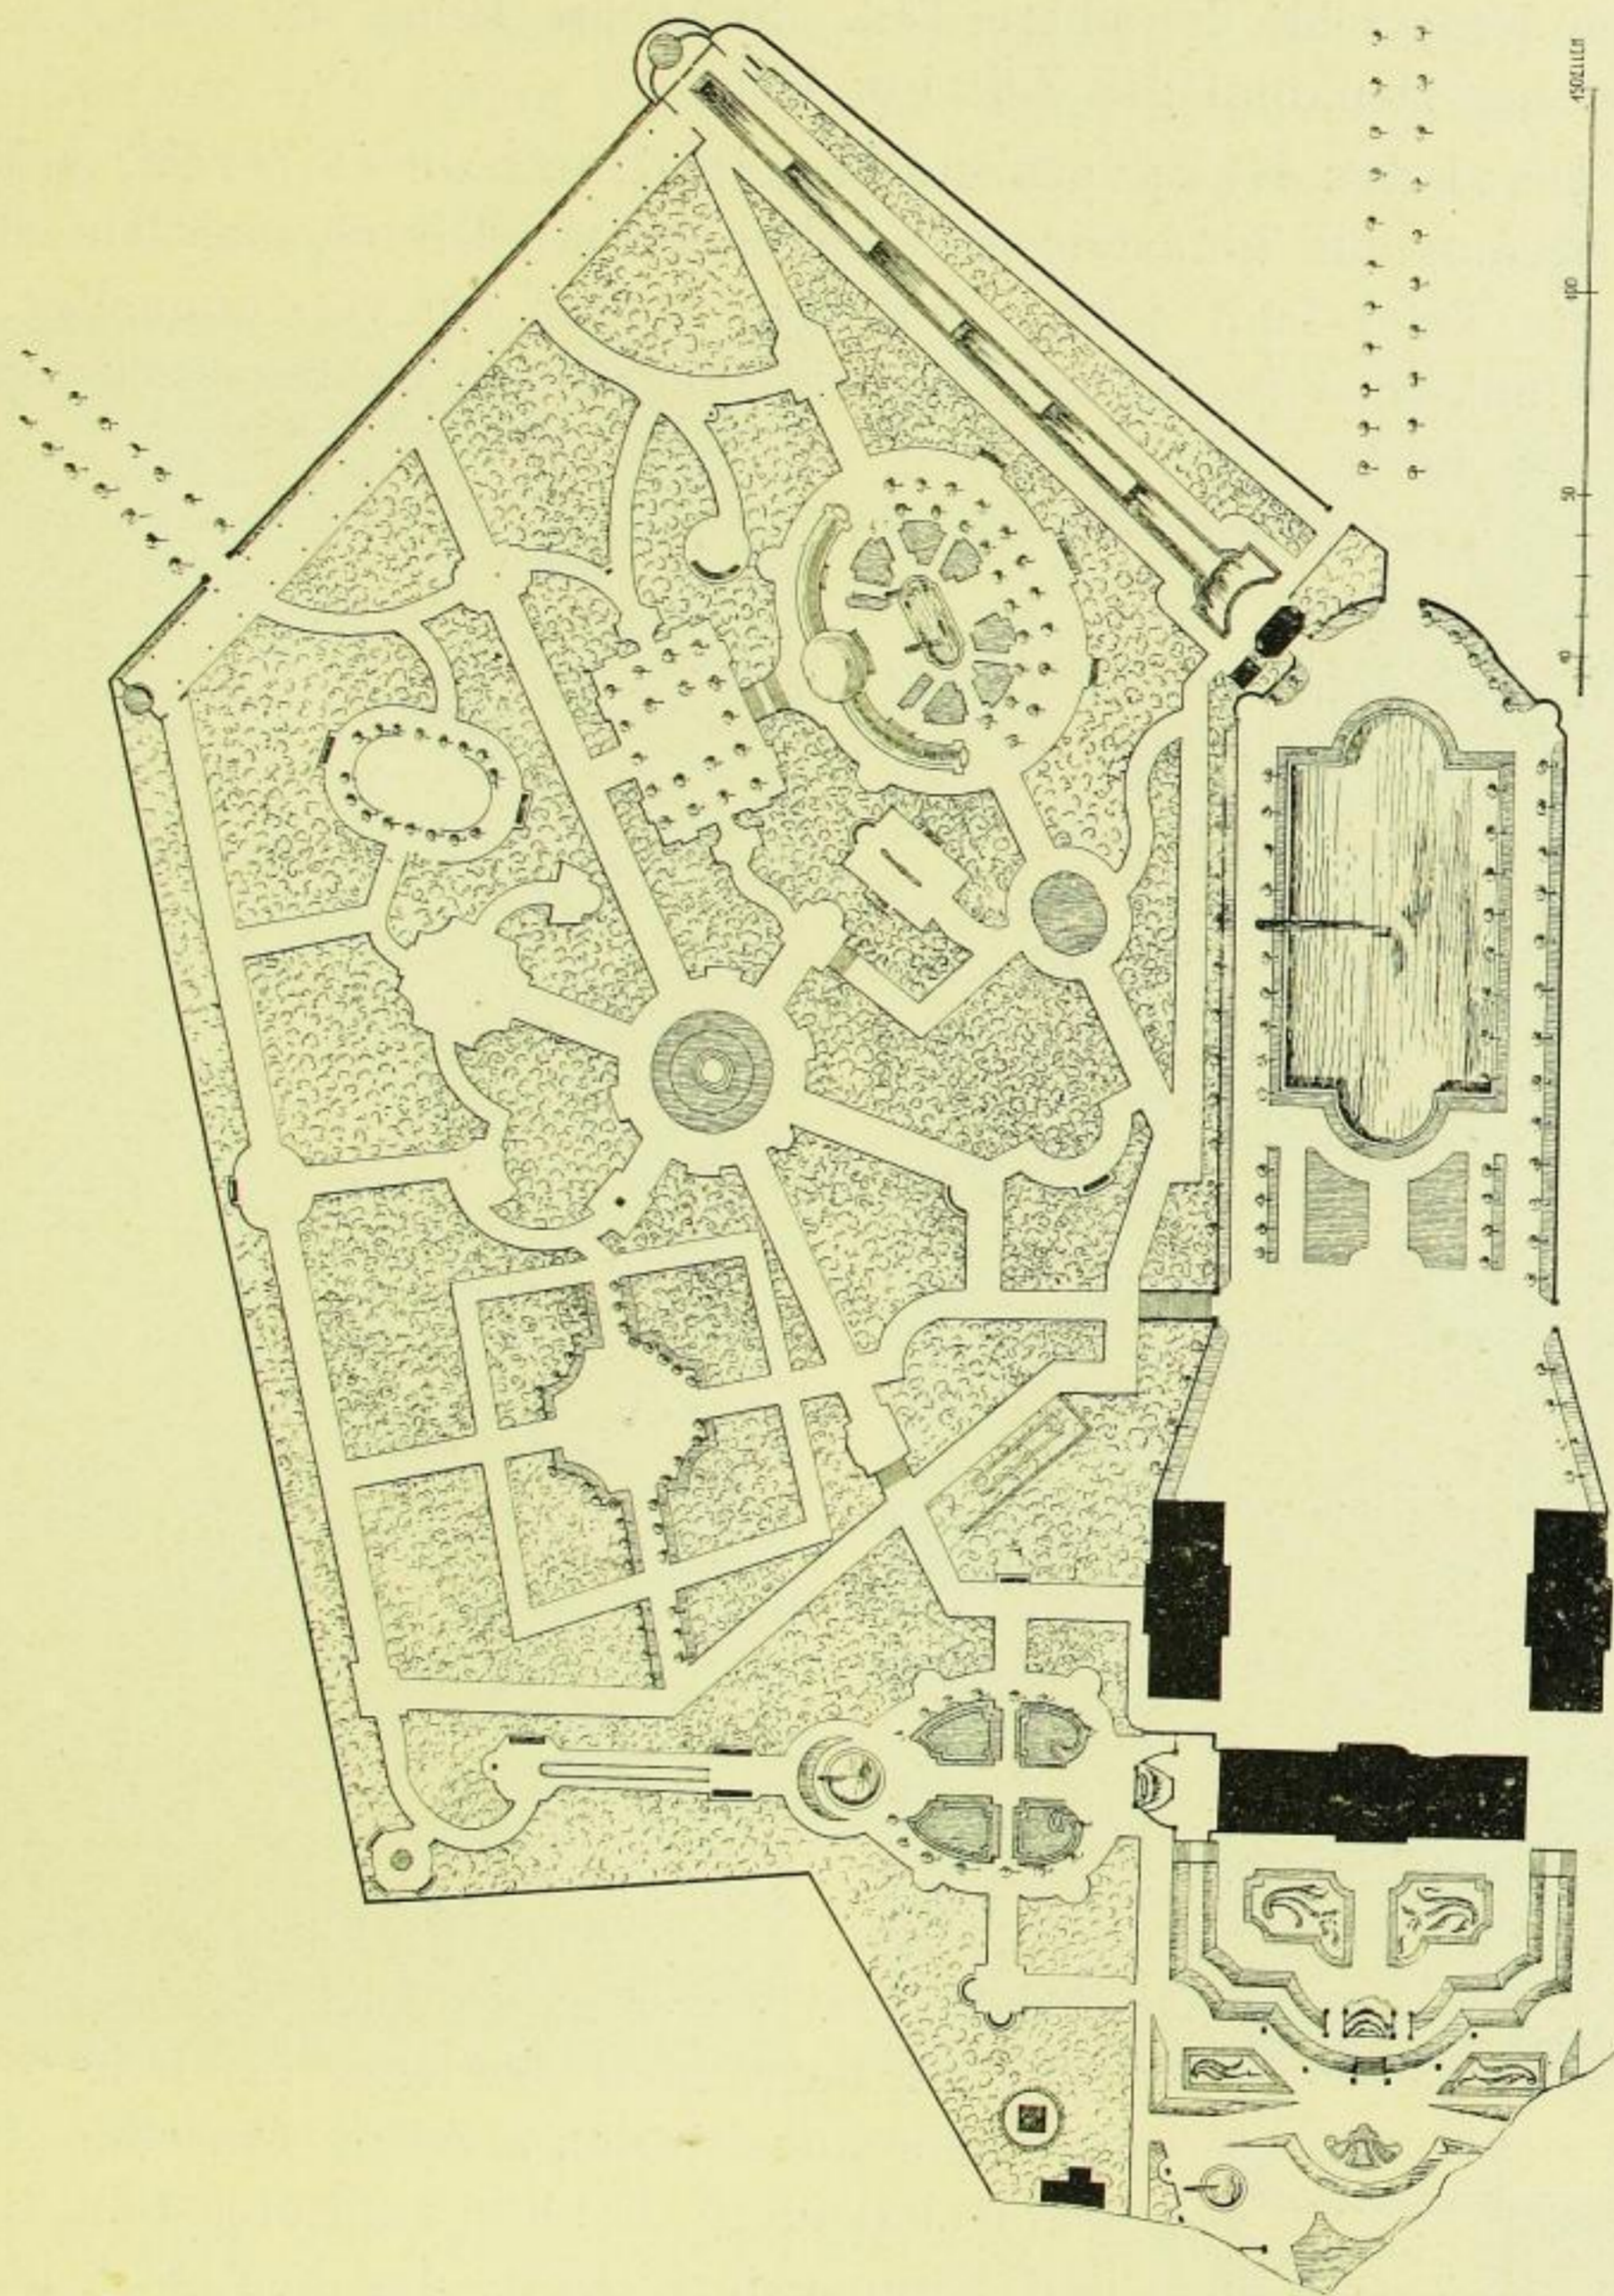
Oberlichtenau, Schloß, Lageplan.
